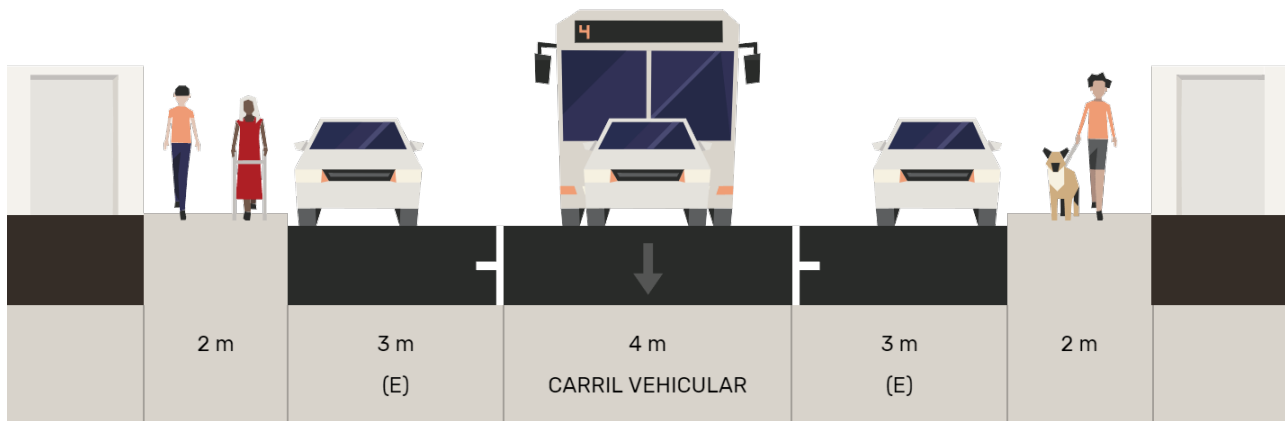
Sección vial propuesta para C. 19 de Julio. Fuente SIGMUN
